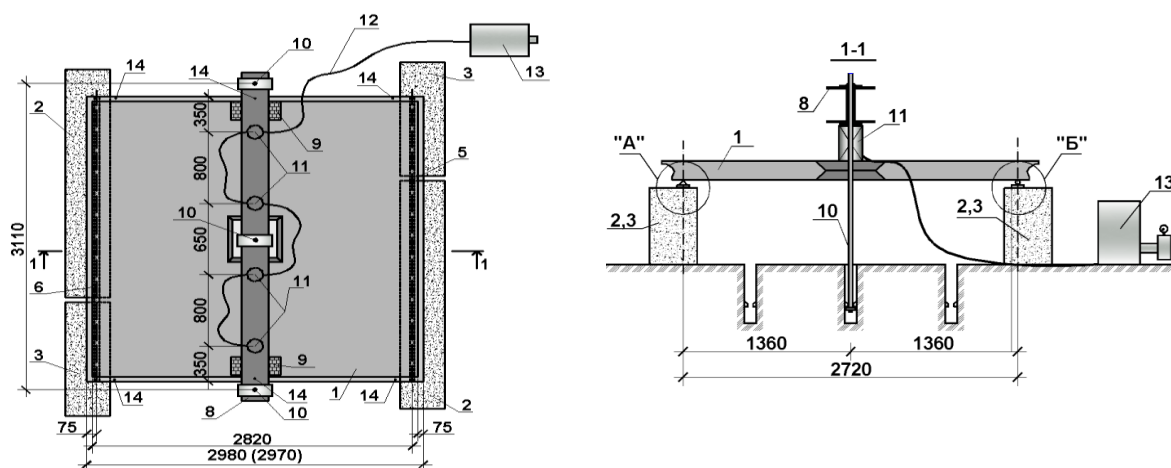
Стенд для випробування надколонної плити: 1 – плита ПН 30.30.1,6–2–1; 2 – блок ФС; 3 – блок ФС; 5 – рухома опора; 6 – нерухома опора (L50x5;100x8); 8 – траверса із швелерів №30; 9 – тимчасові опори; 10 – тяжі з арматури; 11 – гідравлічні домкрати; 12 – напірні трубопроводи; 13 – насосна станція; 14 – індикатори
